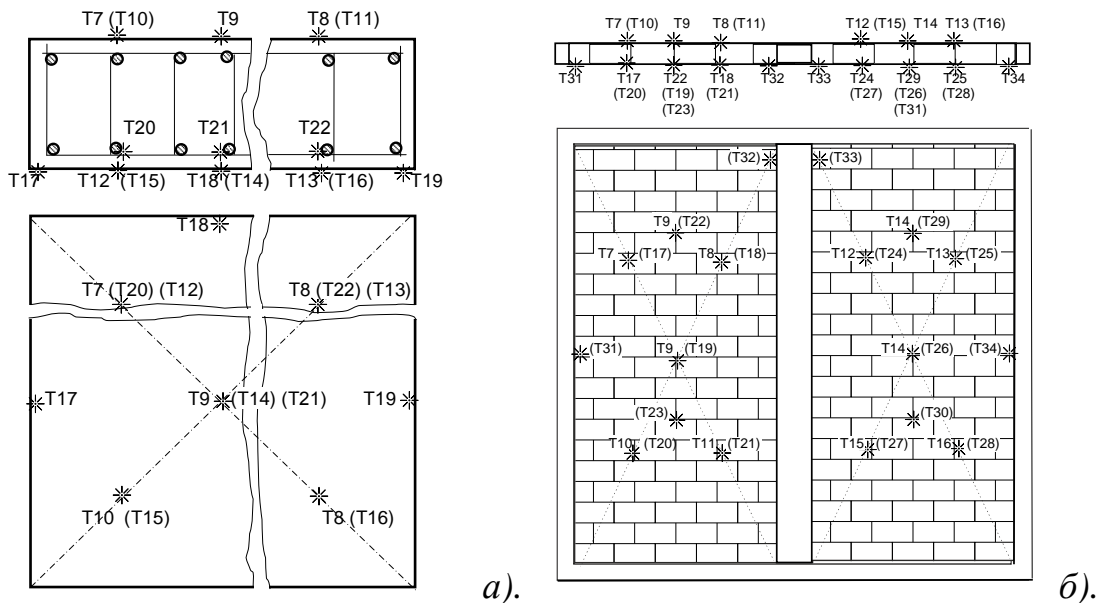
Геометрія перерізу та схема розташування термопар залізобетонного стінового фрагменту-зразка (а) та стінового фрагменту зразка з блоків із легкого бетону (б).
